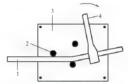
钢筋扳手调直 1一钢筋; 2一扳柱; 3一卡盘; 4一钢筋扳手
